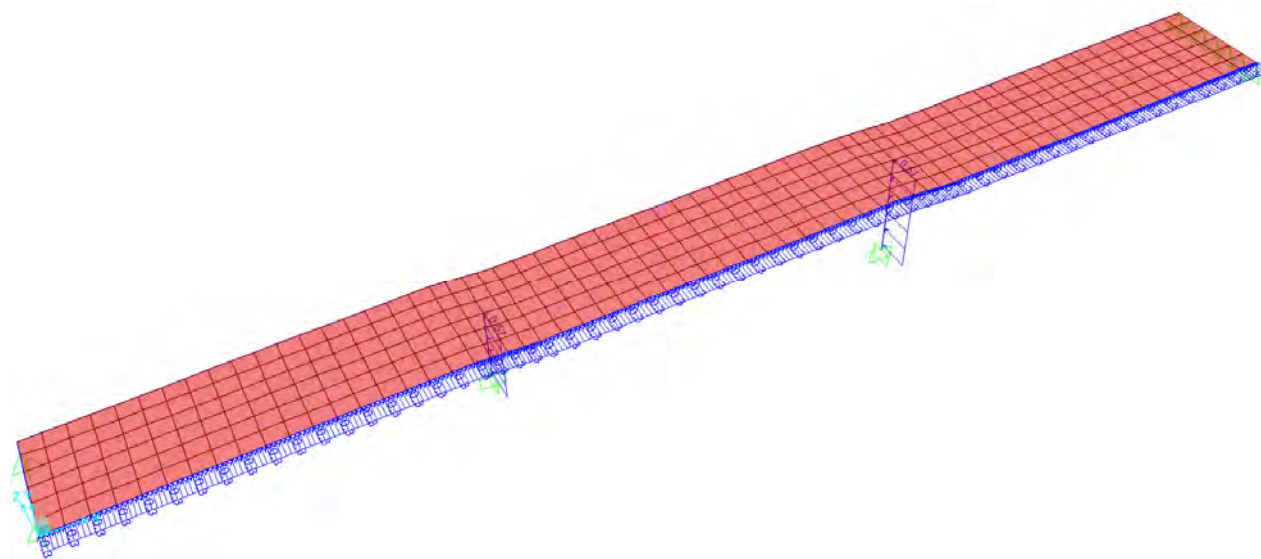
Carga de viento sin sobrecarga en tablero y pilas (*VIENTO*)
